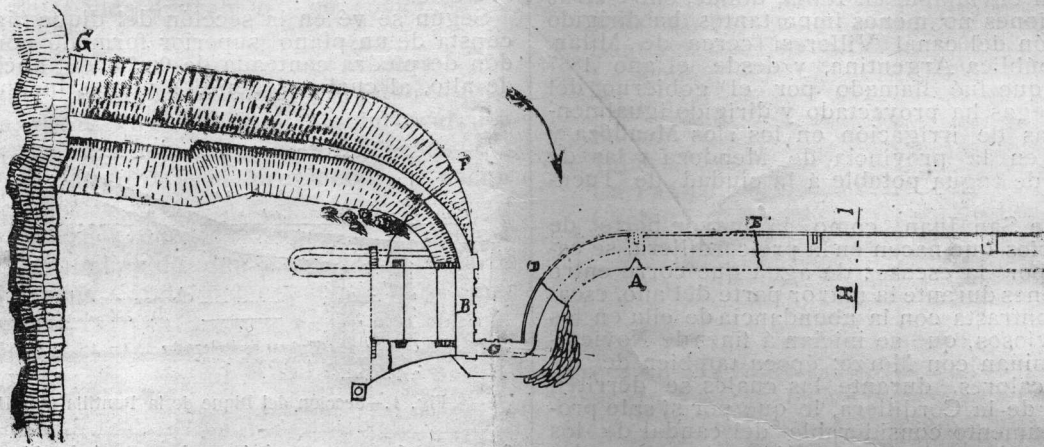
Plano indicando la parte destruída del Dique de la Puntilla
